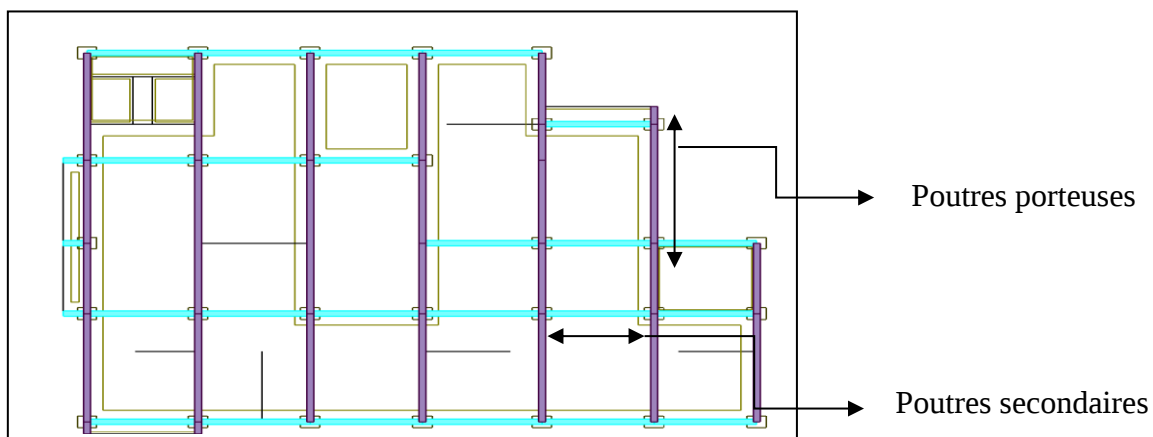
Les poutres porteuses et les poutres secondaires.
